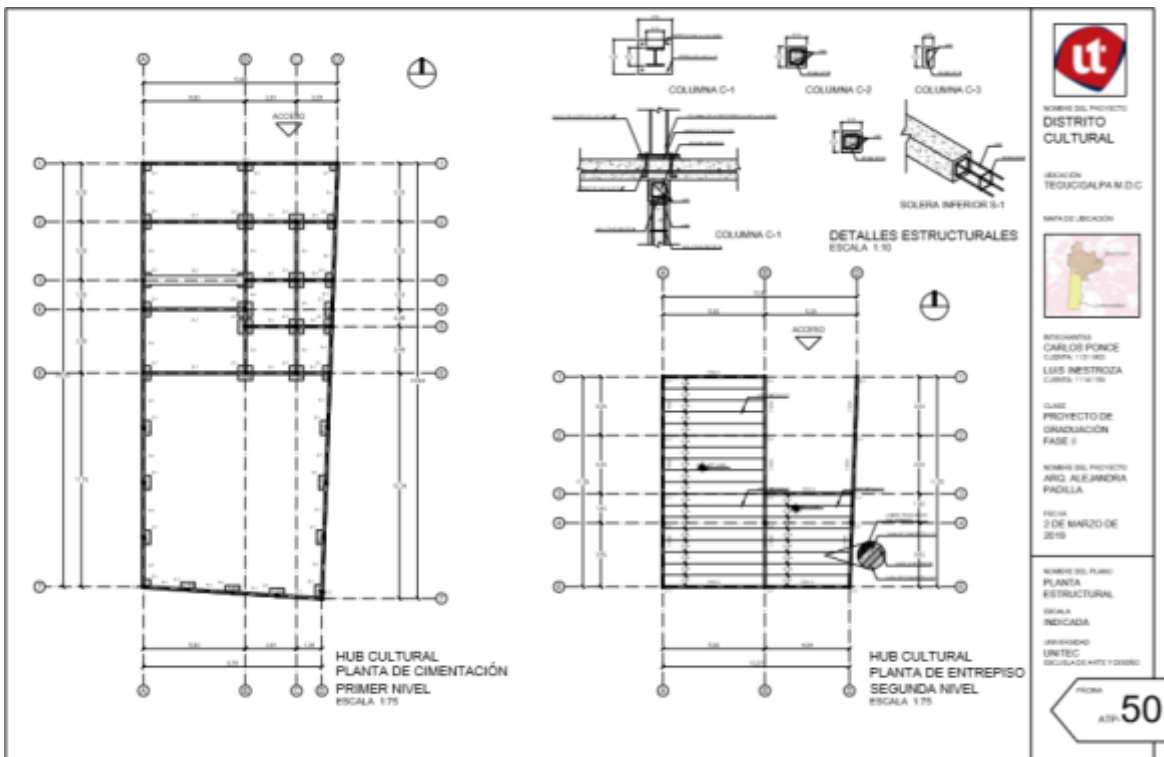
Plantas de Cimentación y Entrepiso Hub Cultural
